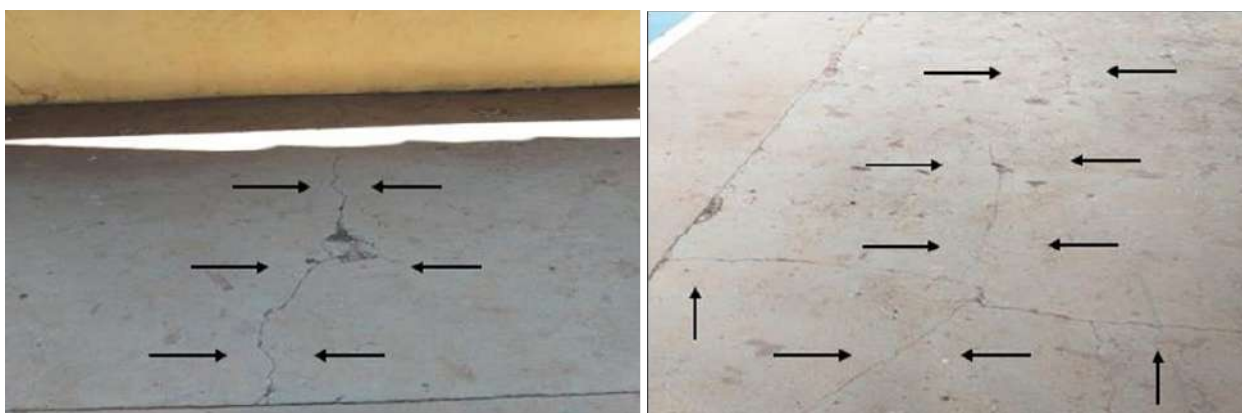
Fissuras de retração em piso de concreto na quadra esportiva.
